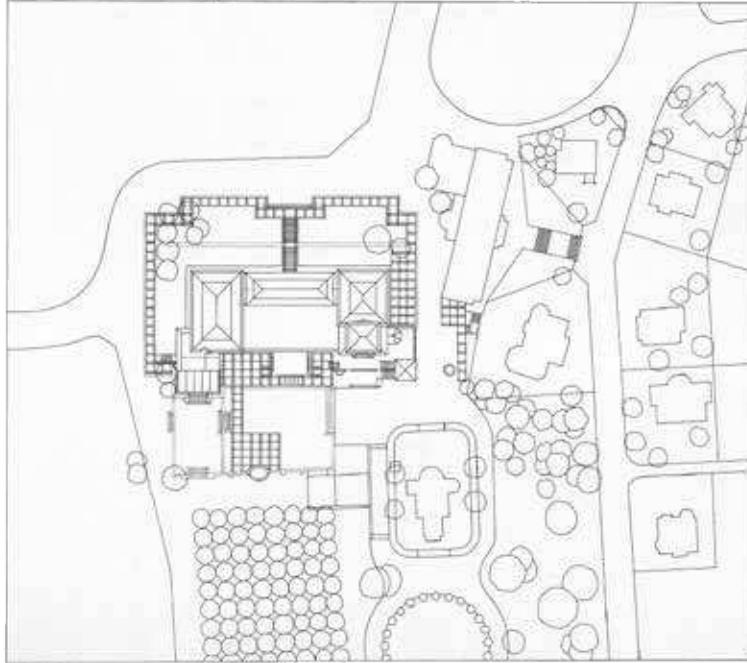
Hochzeitsturm und Ausstellungsgebäude, Lageplan, 1908
